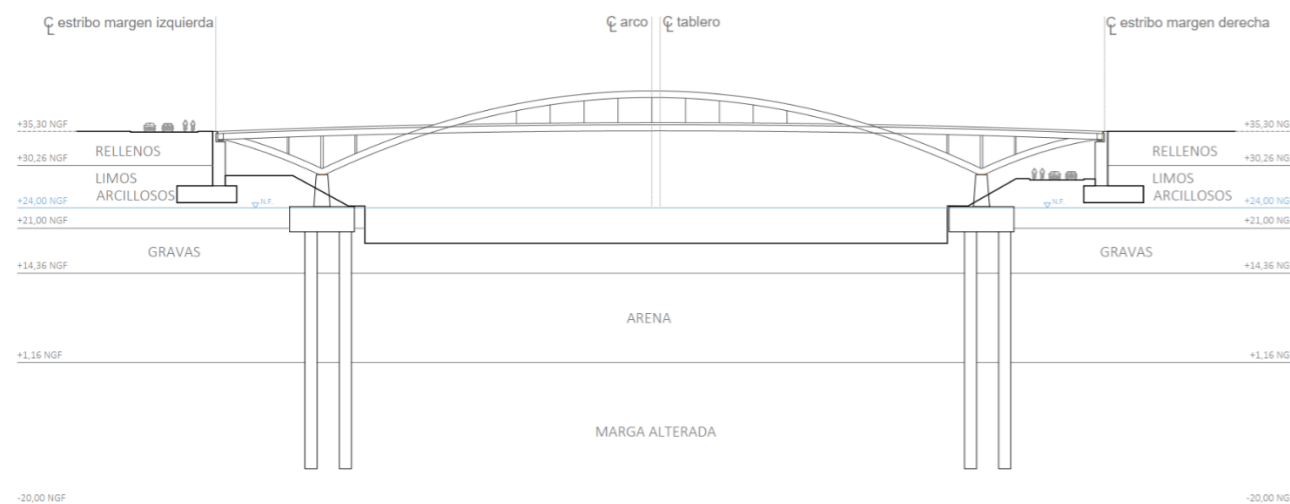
Vista longitudinal de las cimentaciones utilizadas (fuente: elaboración propia)
